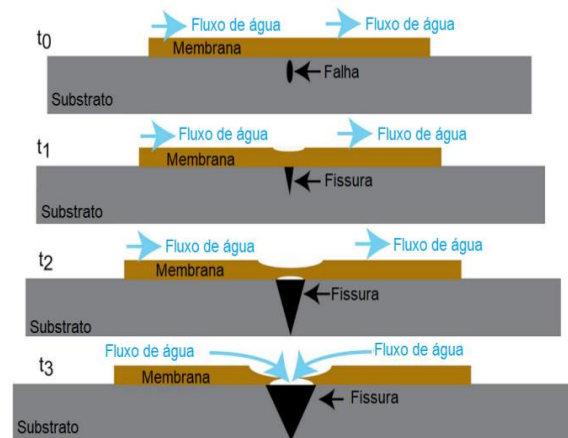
Deformação suportada por um sistema impermeabilizante aplicado sobre trinca.
